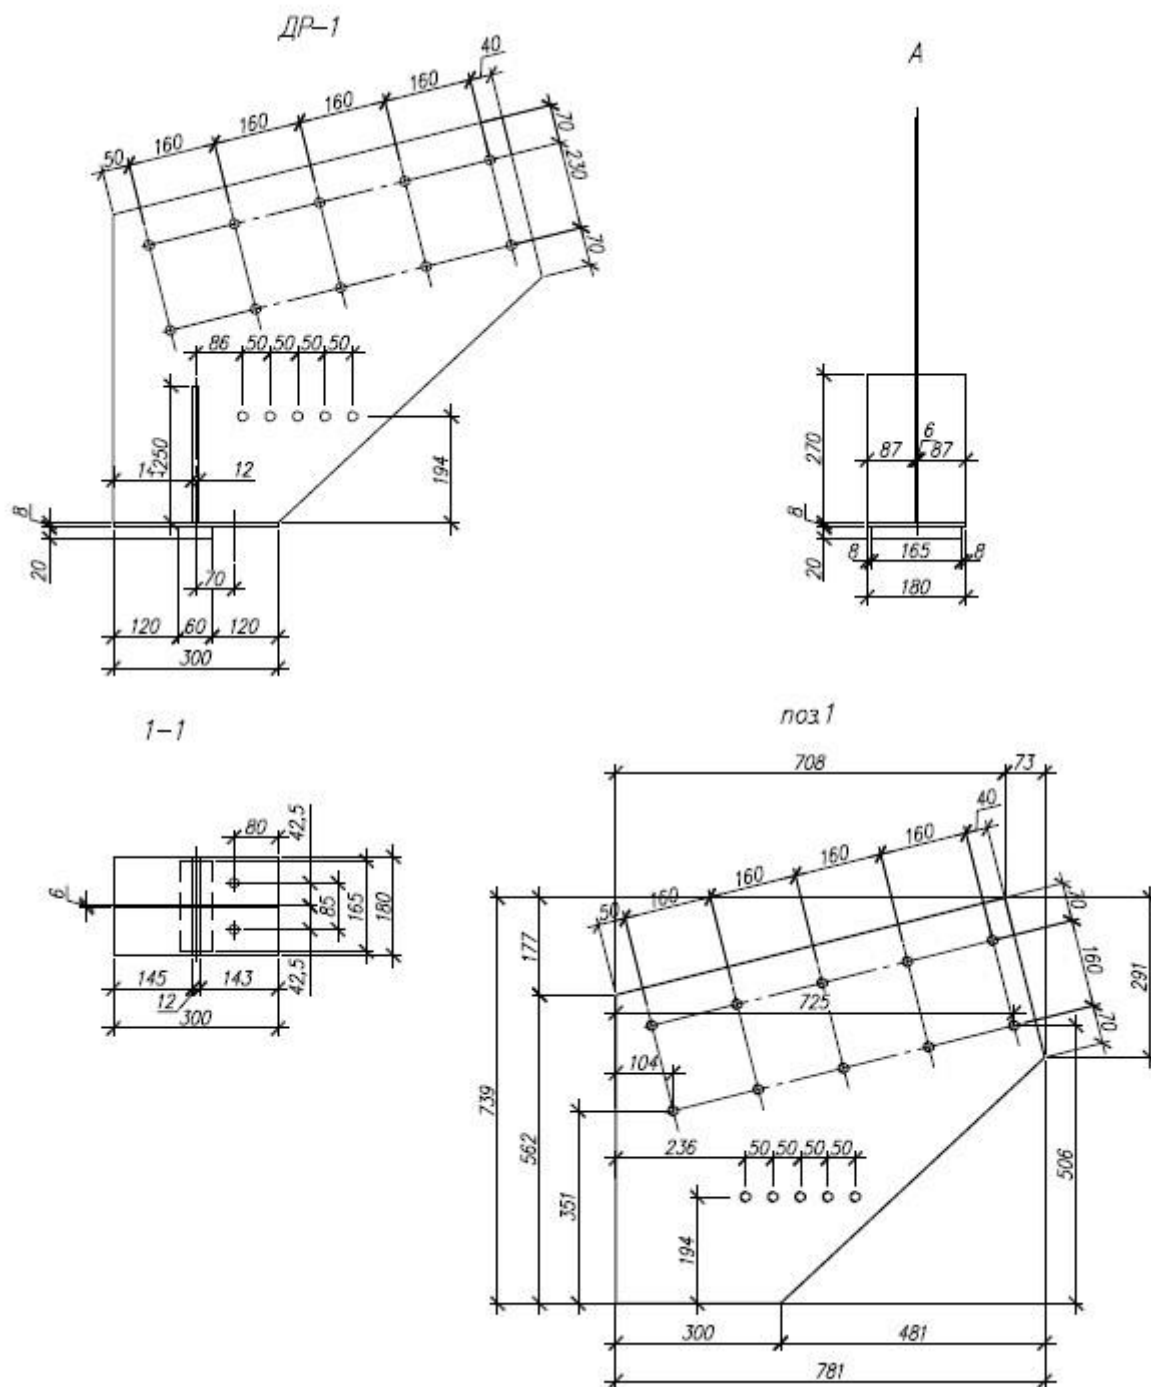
Схемы расстановки болтов в элементах опорного узла 1 ригеля рамы
